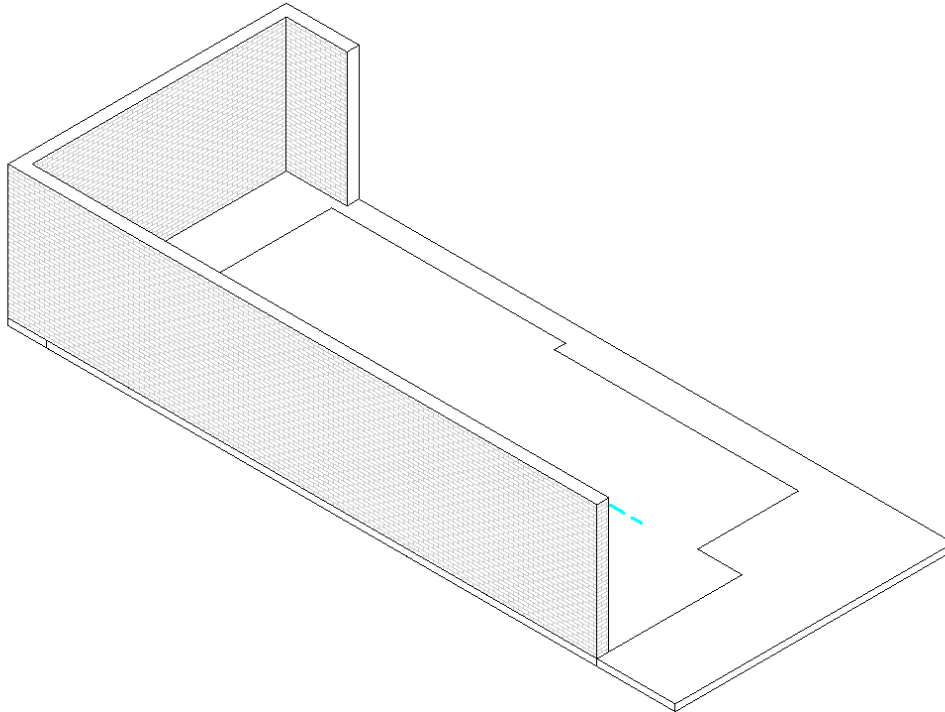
Levantamiento de los muros perimetrales de la casa de interés social.
